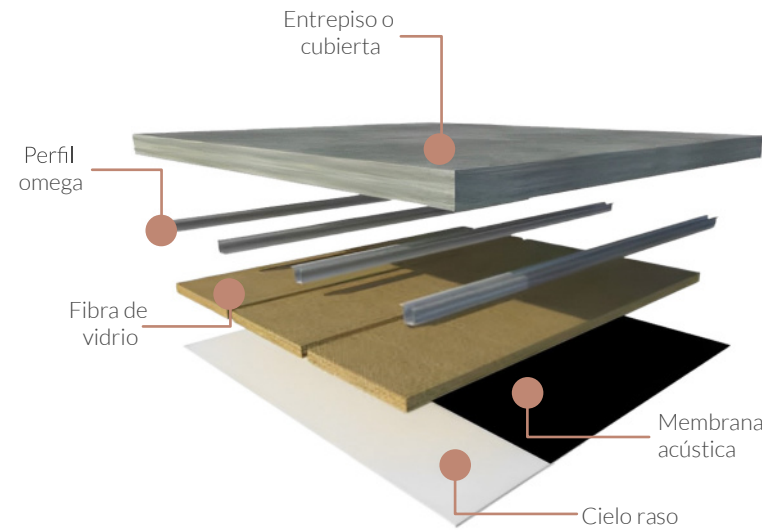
Esquema de aislamiento acústico en entripiso. Elaboración propia basado en la Guía de Adecuación Acústica (2016)
